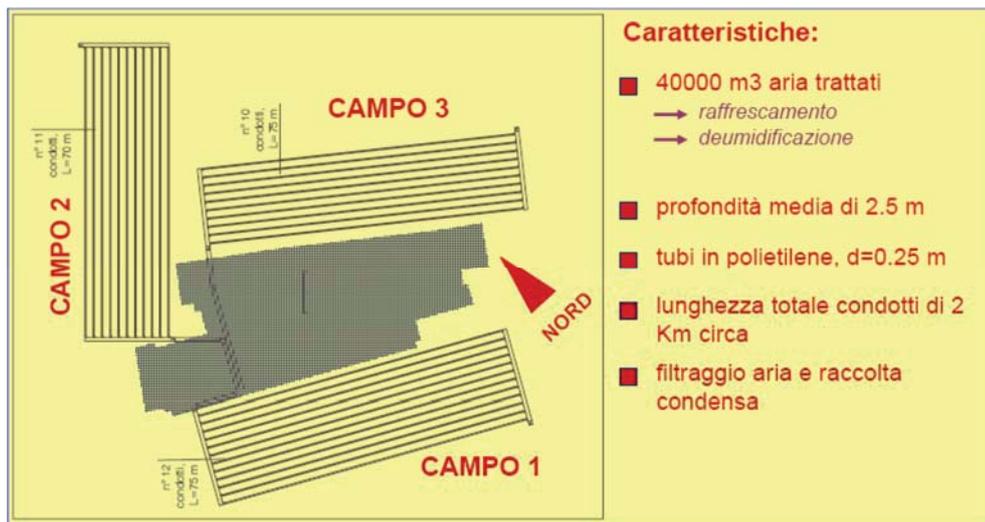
Planimetria dei tre campi del sistema di raffreddamento ventilativo geotermico –Scuola media "Pedagna", Imola (BO) progettazione impiantistica: Metec & Saggese Engineering, Torino;
